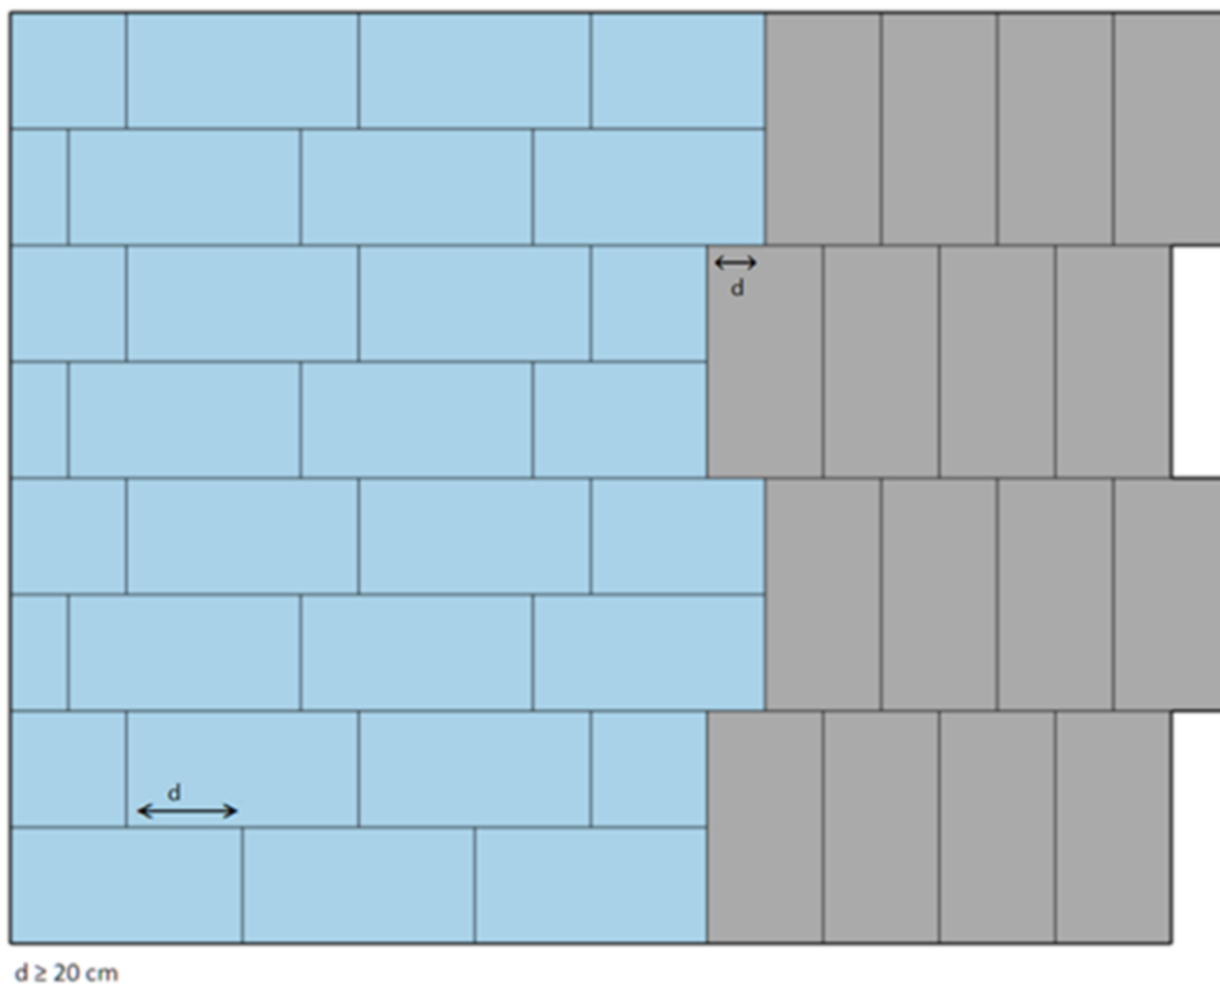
Juxtaposition des poses horizontales et verticales des panneaux isolants sur une même façade
